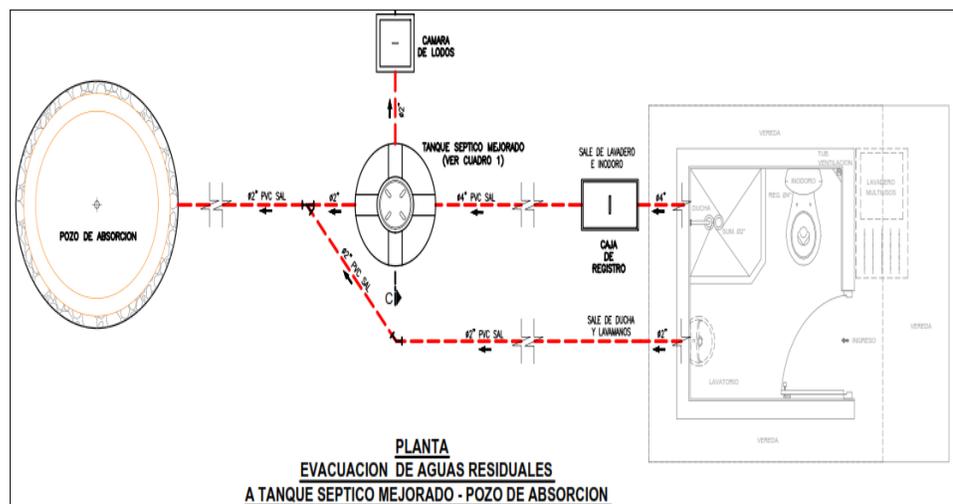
Vista en planta de los componentes de la UBS con arrastre hidráulico.
